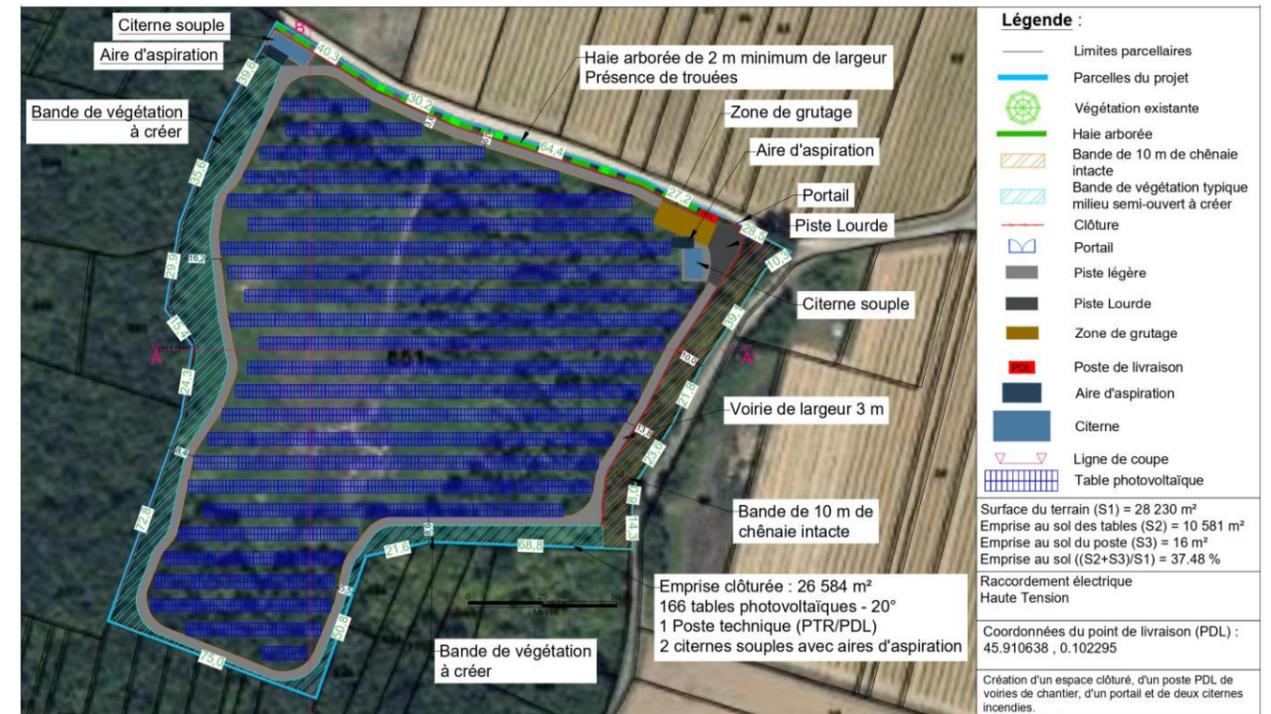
Plan de masse lors du dépôt du dossier de permis de construire
